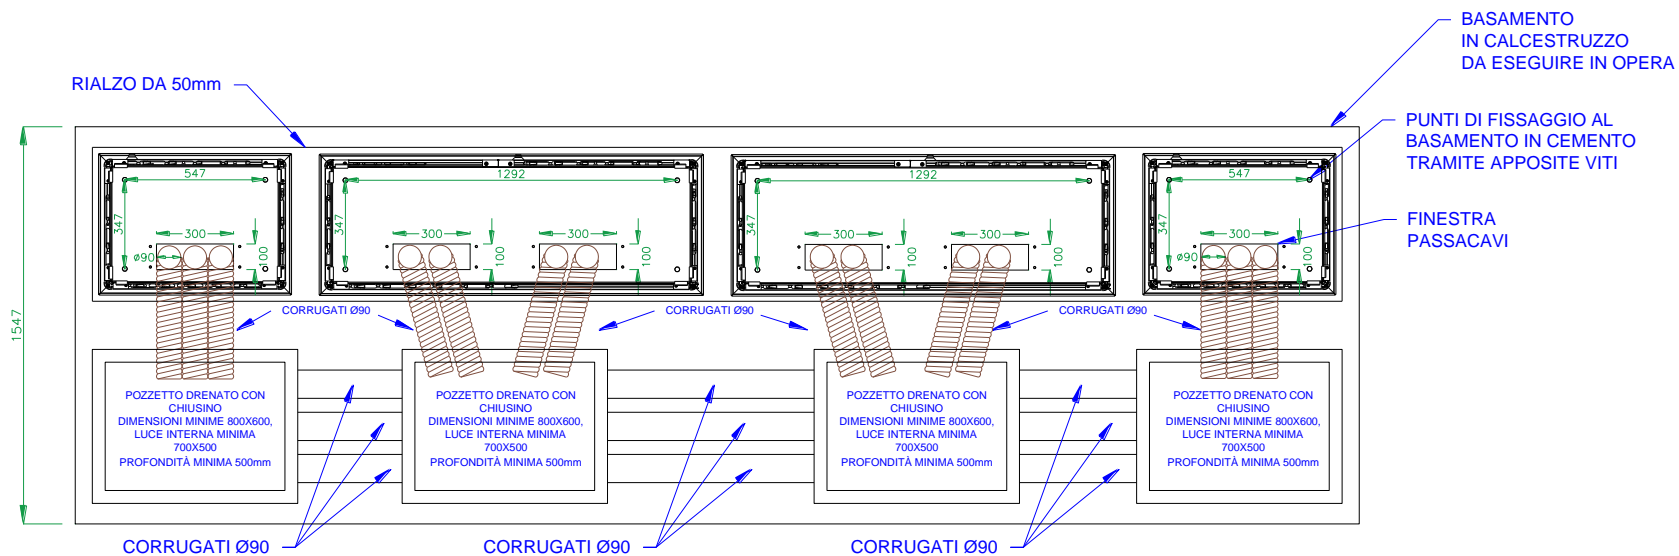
Tipico installazione quadri elettrici di fermata – Vista dall'alto
